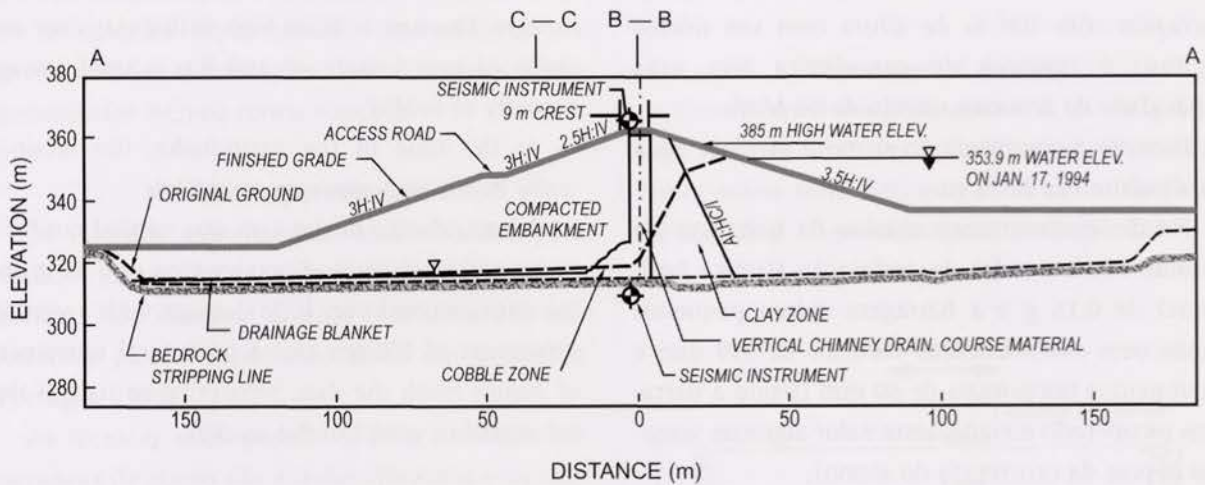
Perfil tipo da barragem de Los Angeles (segundo David e Bardet, 1996)
